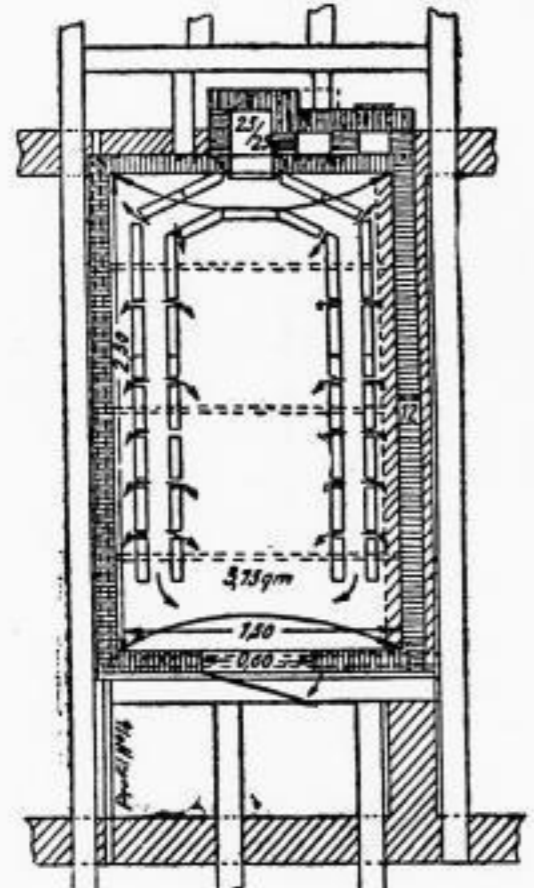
Räucherlampe im Dachboden (Grundriss).
